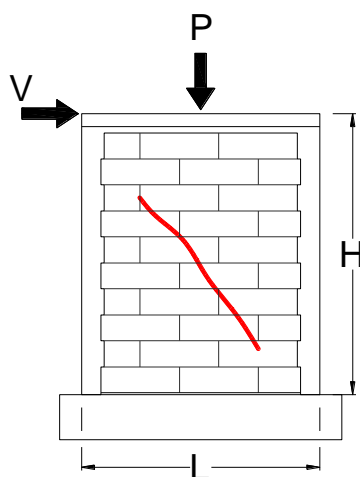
Grieta de cortante en un muro confinado
